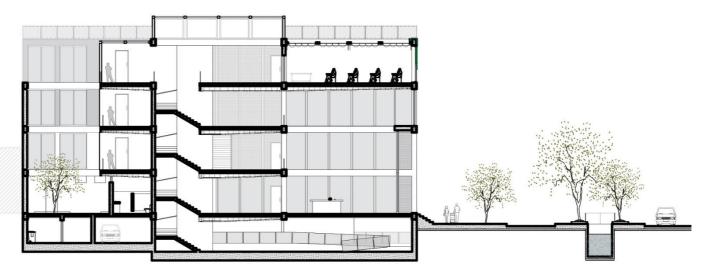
Corte transversal 2 Fuente: elaboración propia
